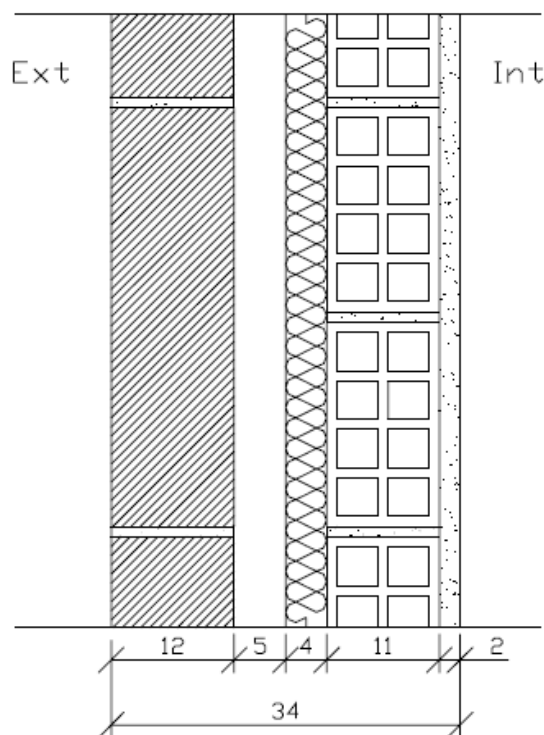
Pormenor construtivo de uma parede dupla em pedra aparente e tijolo perfurado (Sistemas de Fachadas Universidade do Minho, 2011)
